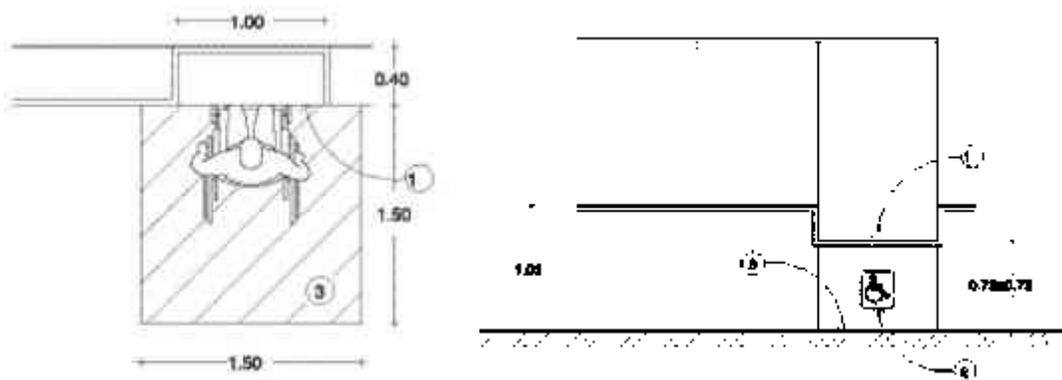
de fachada y alzado del mostrador y su área adecuada. Obtenida de las Normas de Recomendaciones de Accesibilidad.
